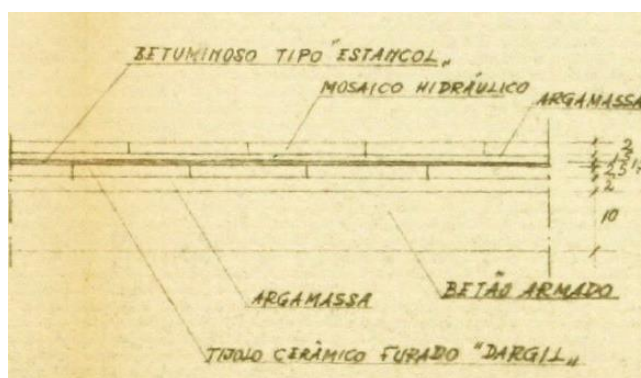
Pormenor da cobertura, antes do prolongamento da estrutura para execução do piso 7
